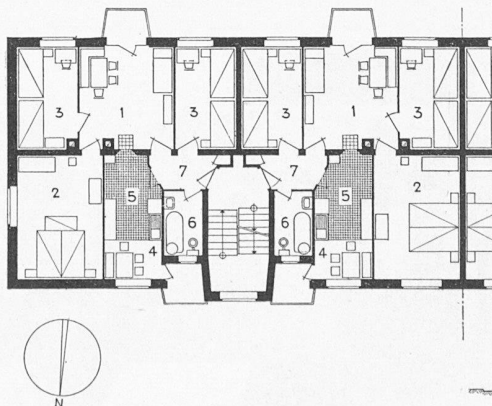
Vierzimmer-Grundriss, Masstab 1:300
